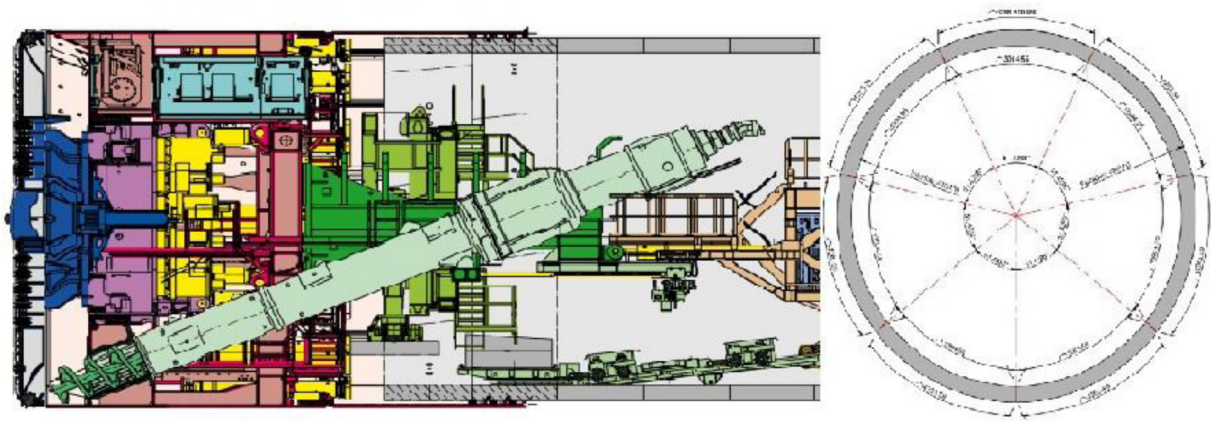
Coupe du tunnelier EPB et des anneaux.
